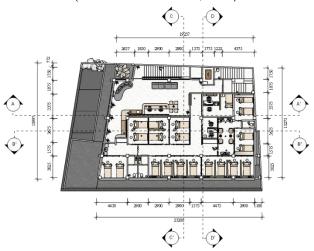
Layout* Baru Lantai Tiga (Sumber: Tessalonika, 2024)
